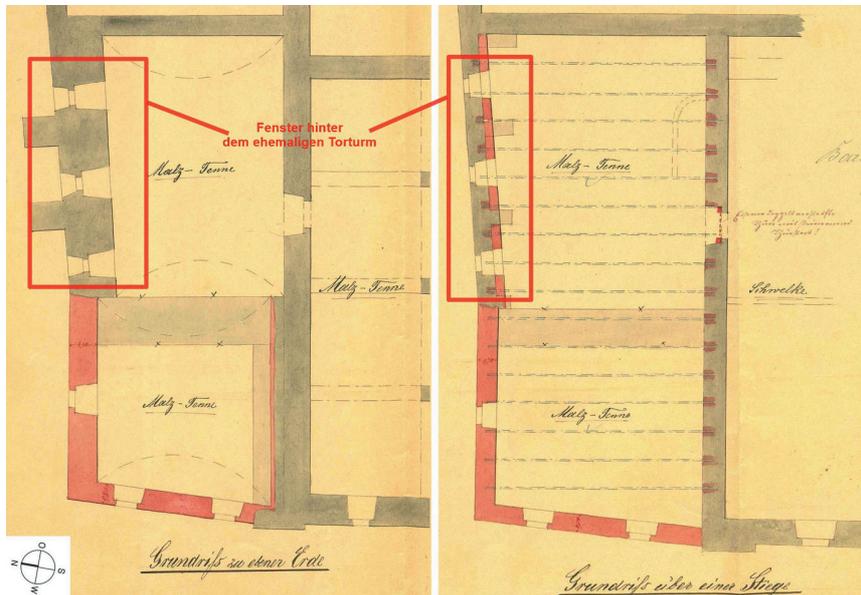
KG-Grundriss (links) und EG-Grundriss (rechts) für den Umbau und die Vergrößerung der Malz-Tenne aus dem StAAm/Bezirksamt Landratsamt Cham, Baugenehmigungsakte 134/1894 (Einbauten sind rot eingefärbt/abgetragenes Mauerwerk ist hellgrau eingefärbt/eingebaute Fenster hinter dem ehemaligen Torturm sind rot markiert)
